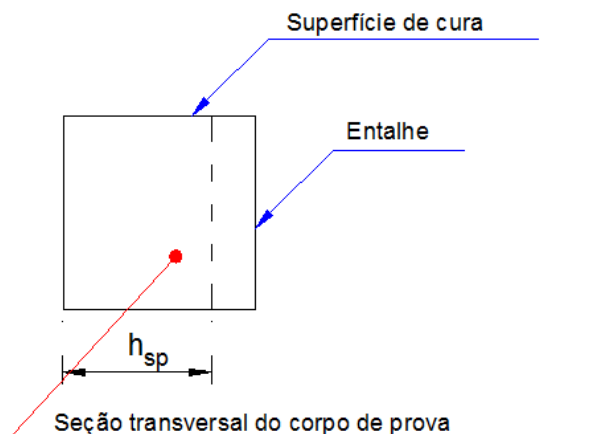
Posição do entalhe serrado na viga de teste (adaptado RILEM TC 162, 2003).
